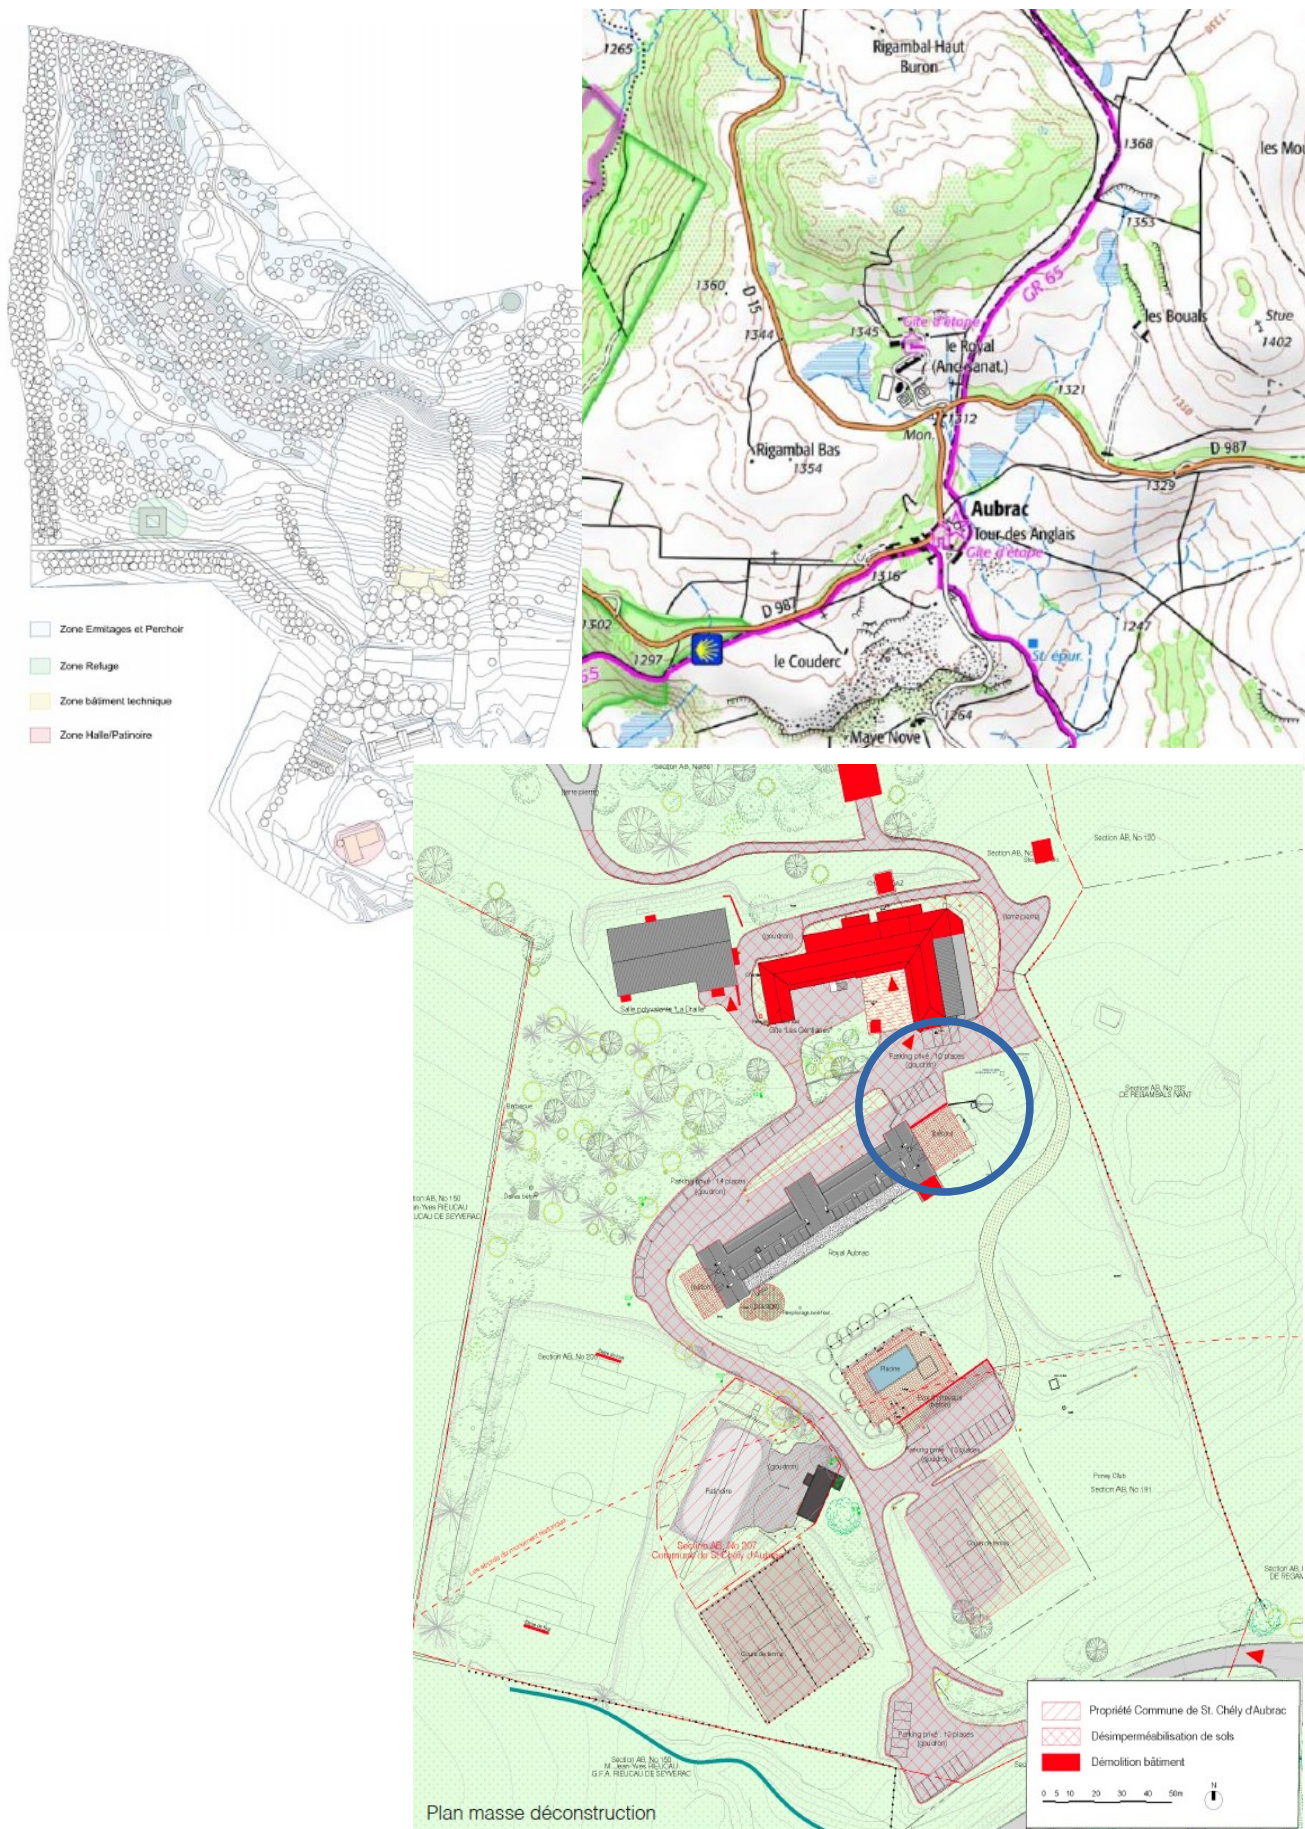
Plan de situation et plan de déconstruction de l'UTN Royal Aubrac
